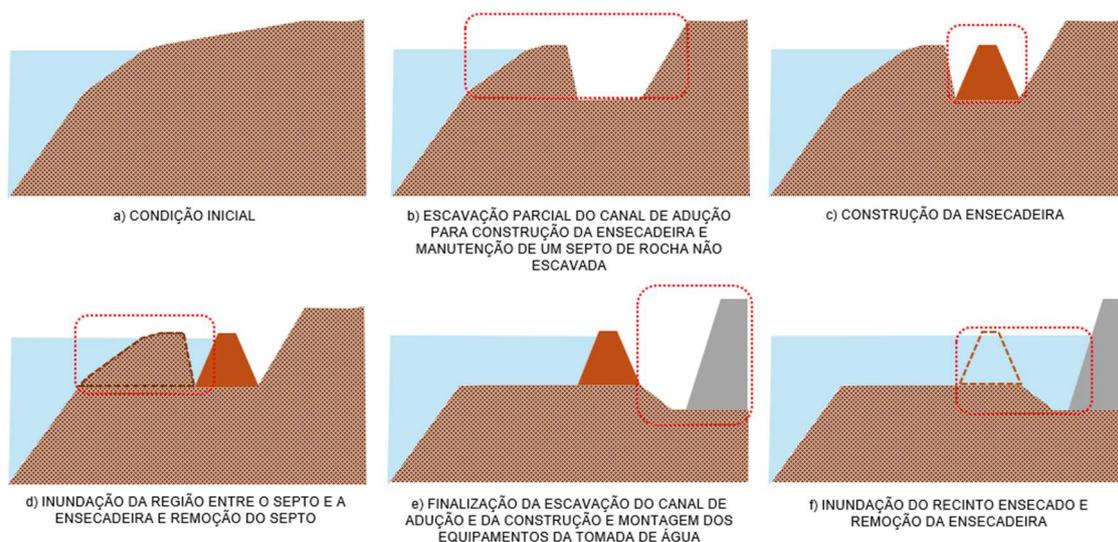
Sequência construtiva da escavação do canal de adução e implantação da ensecadeira.
